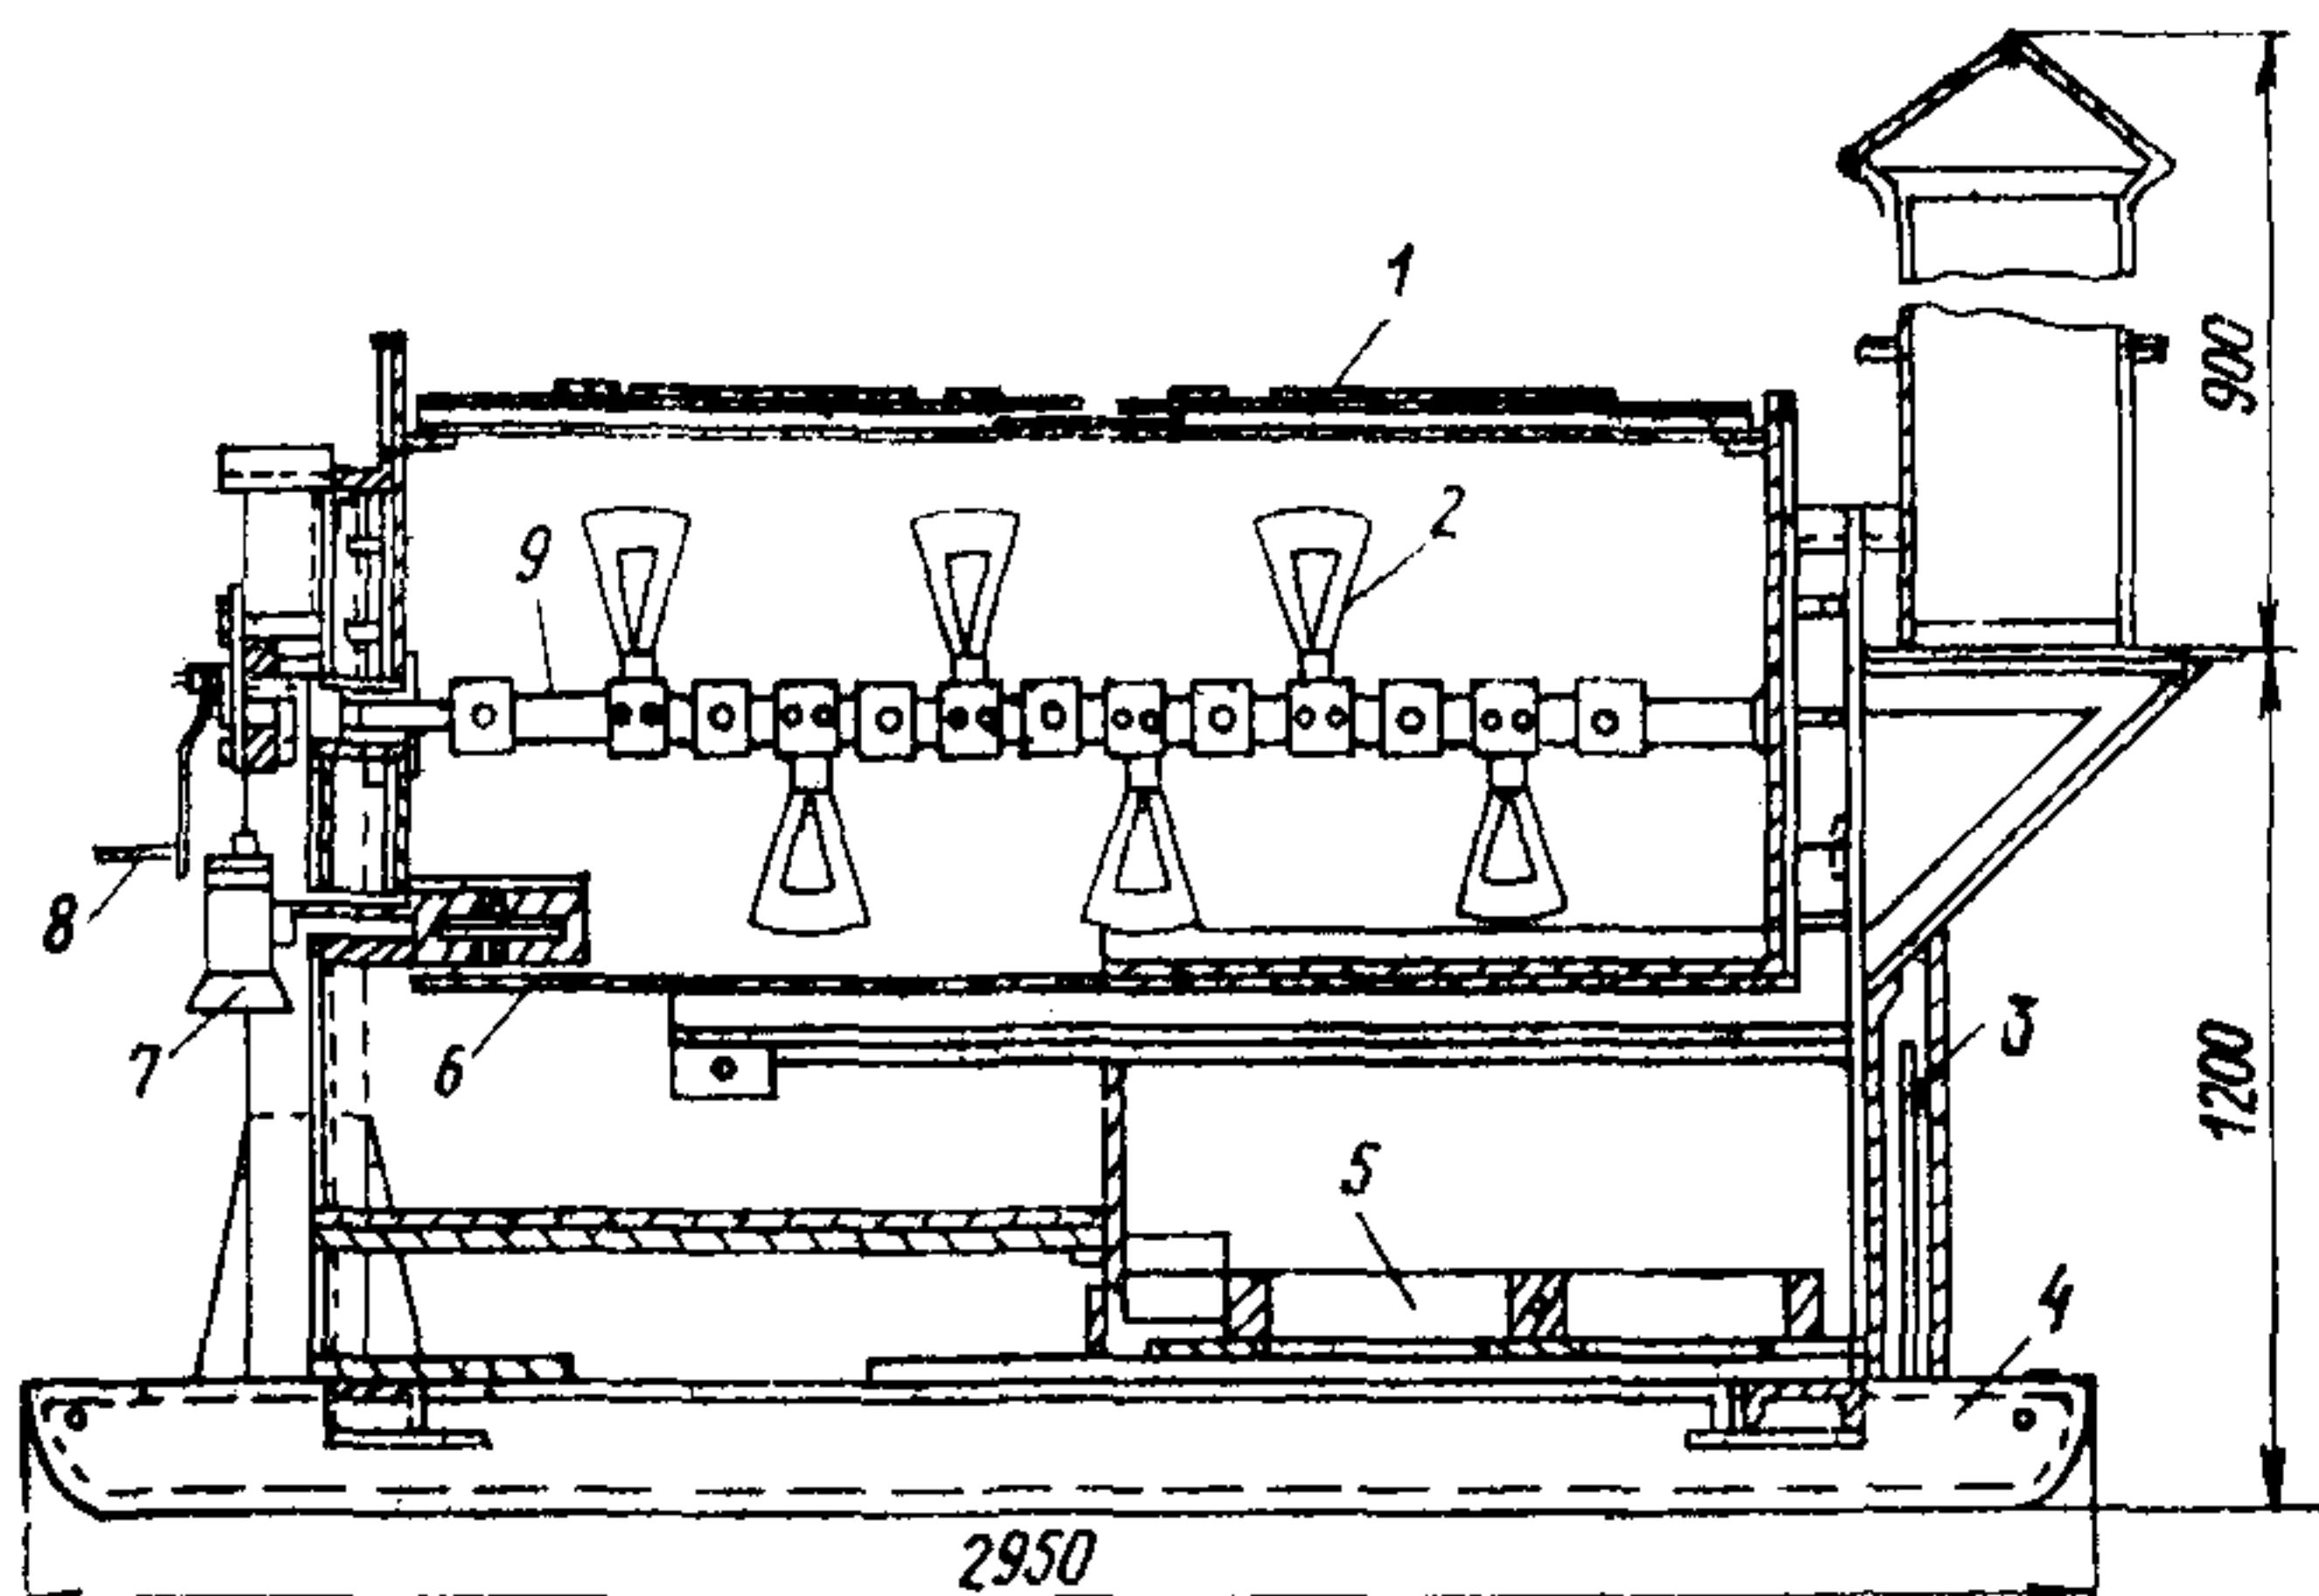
Битумоварочный котел конструкции Союзспецстроя
